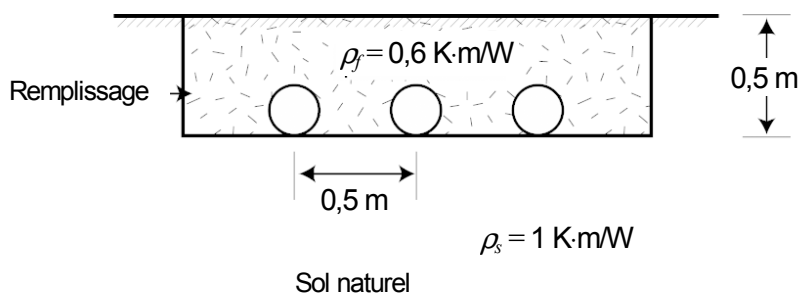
Câbles de forte section posés dans un caniveau à faible profondeur
